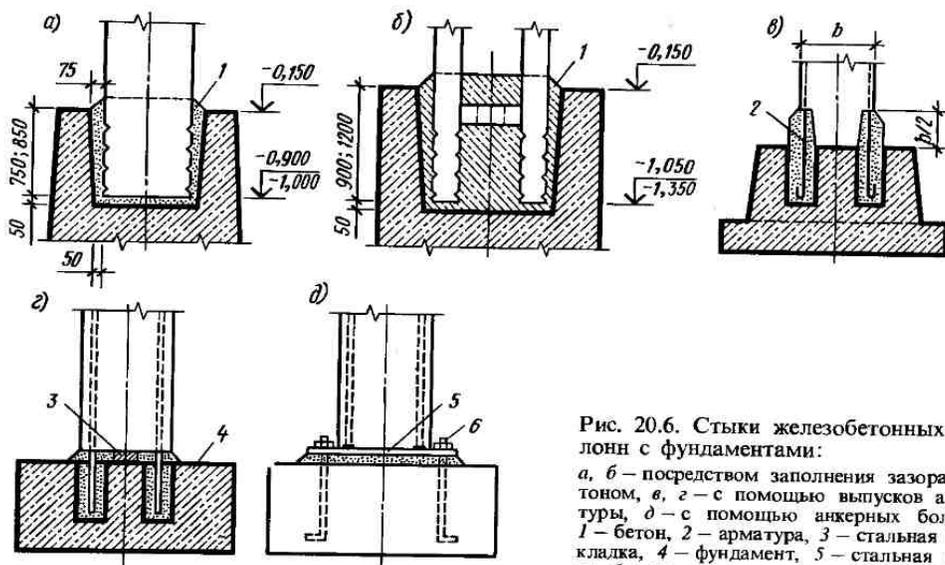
Стыки железобетонных колонн с фундаментами:
